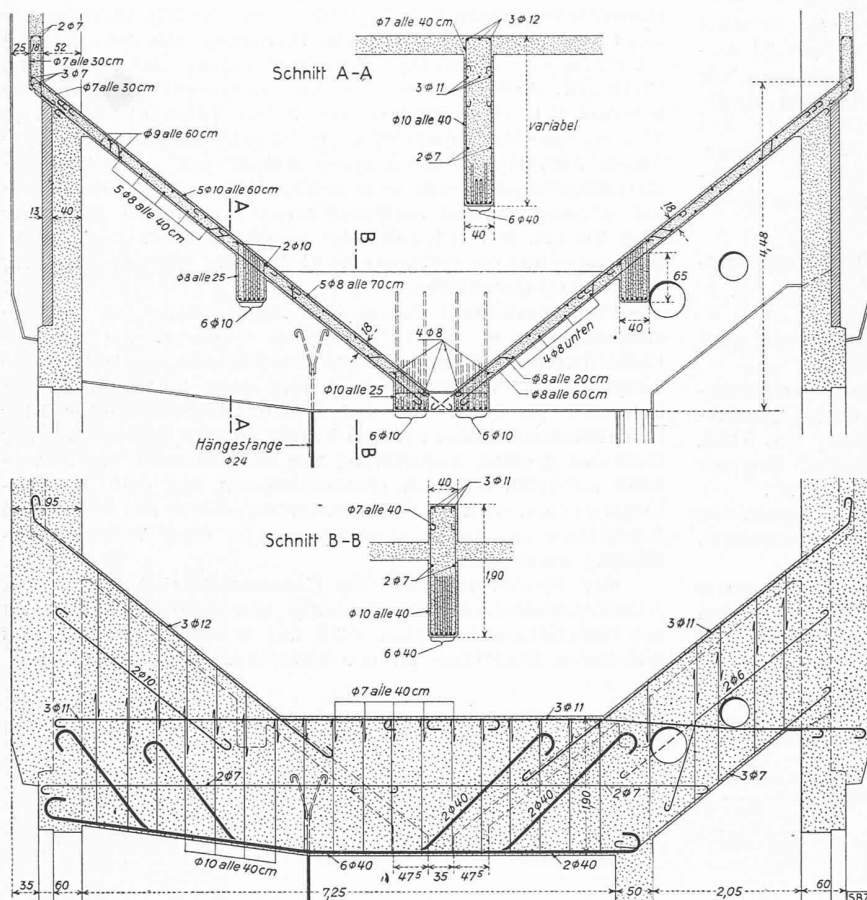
Eisenbetonkonstruktion 1:100, oben Schnitt D-D, unten Schnitt C-C (vgl. Bild 15)
